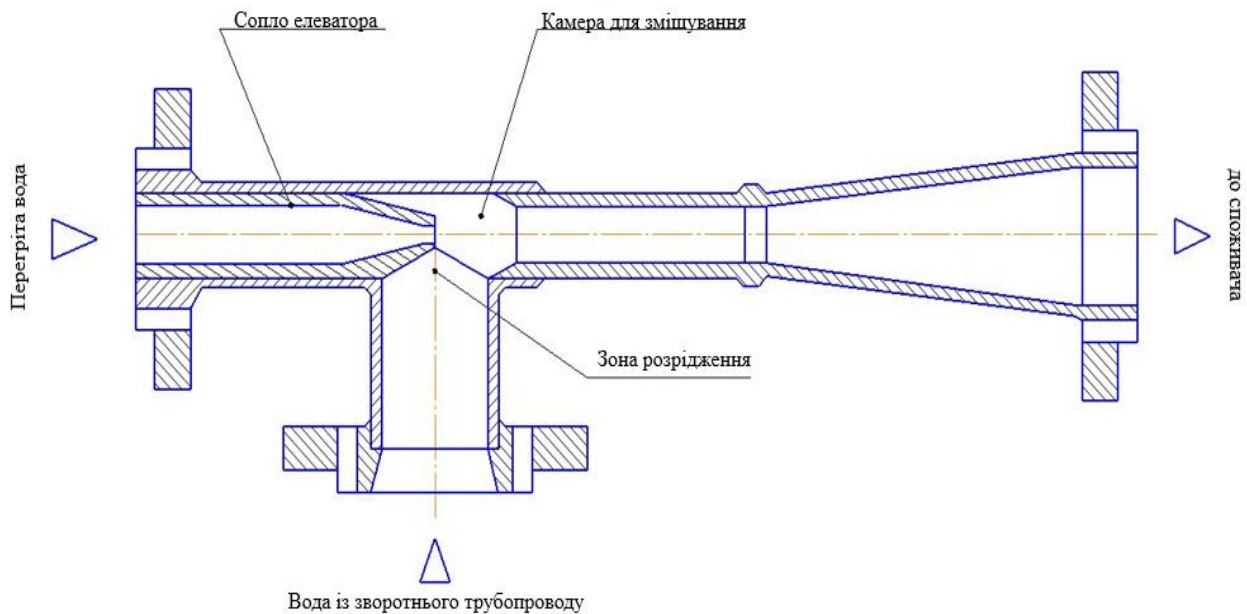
Принципова схема конструкції елеваторного вузла
